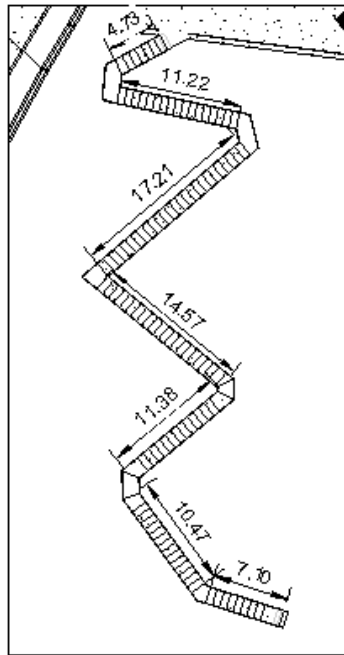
Vista en planta de escaleras. (Bodero & Romero, 2022)
